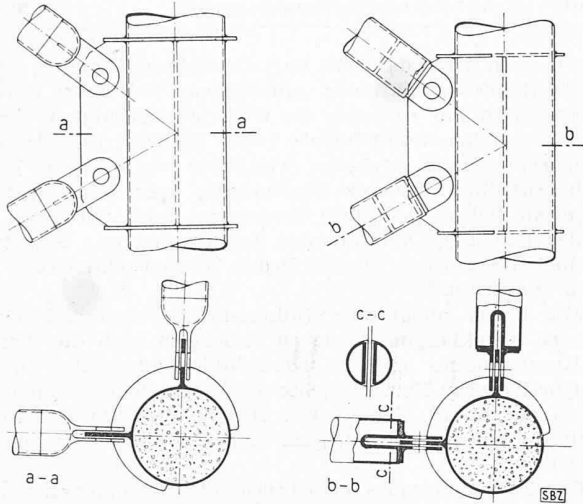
Ausführungsarten von Knotenpunkten. a Rohrenden aus angeschweissten Stahlgussteilen; b Eingeschweisste Klammern aus Flacheisen
